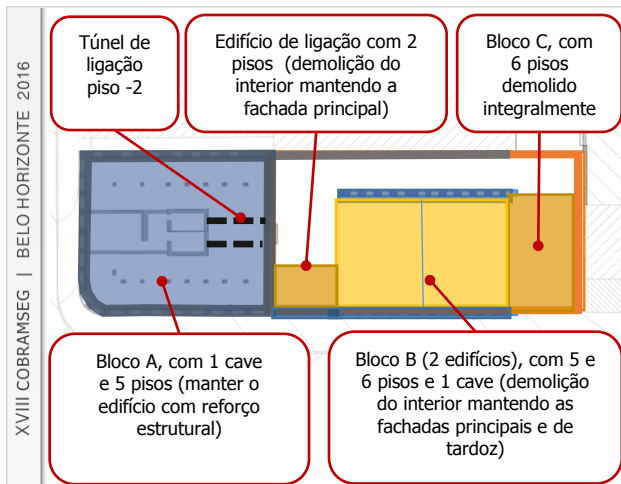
Planta dos edifícios existentes no local da intervenção.
